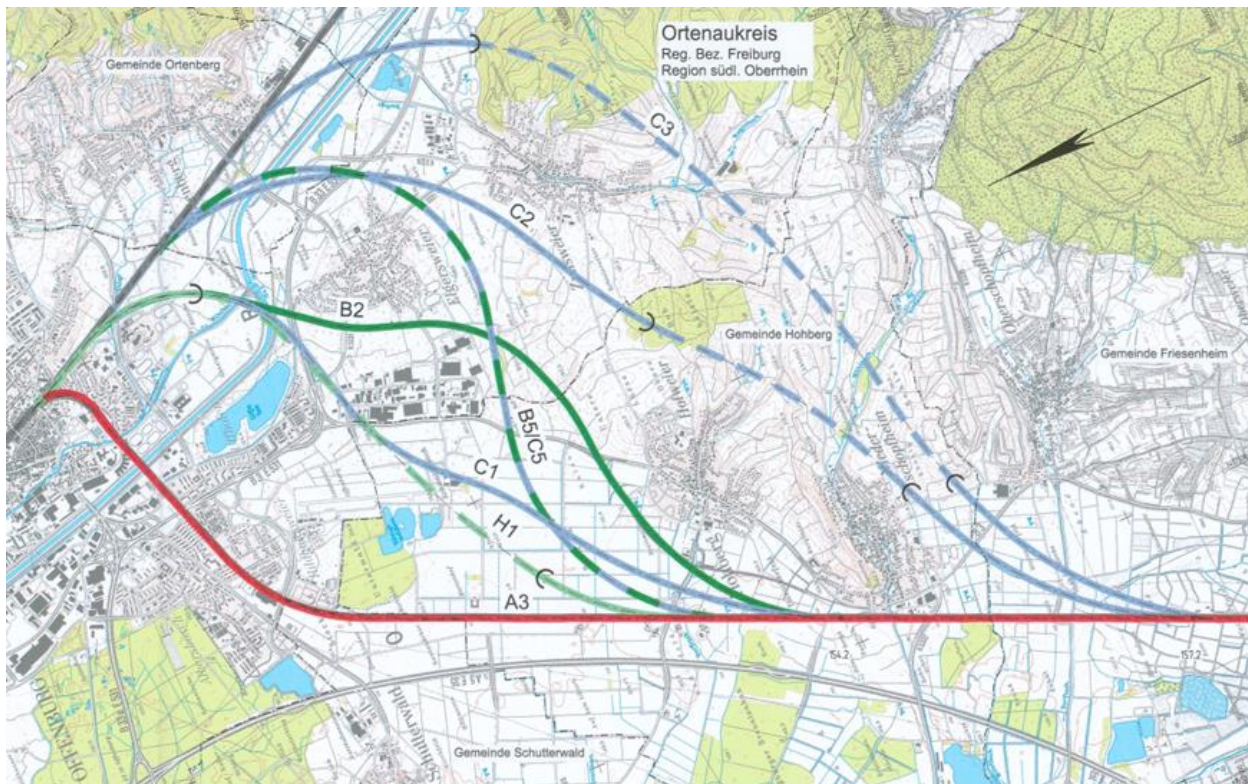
Übersichtslageplan der Untersuchungsrelevanten Trassenvarianten ROV (Quelle: BUNG GmbH 2001)
